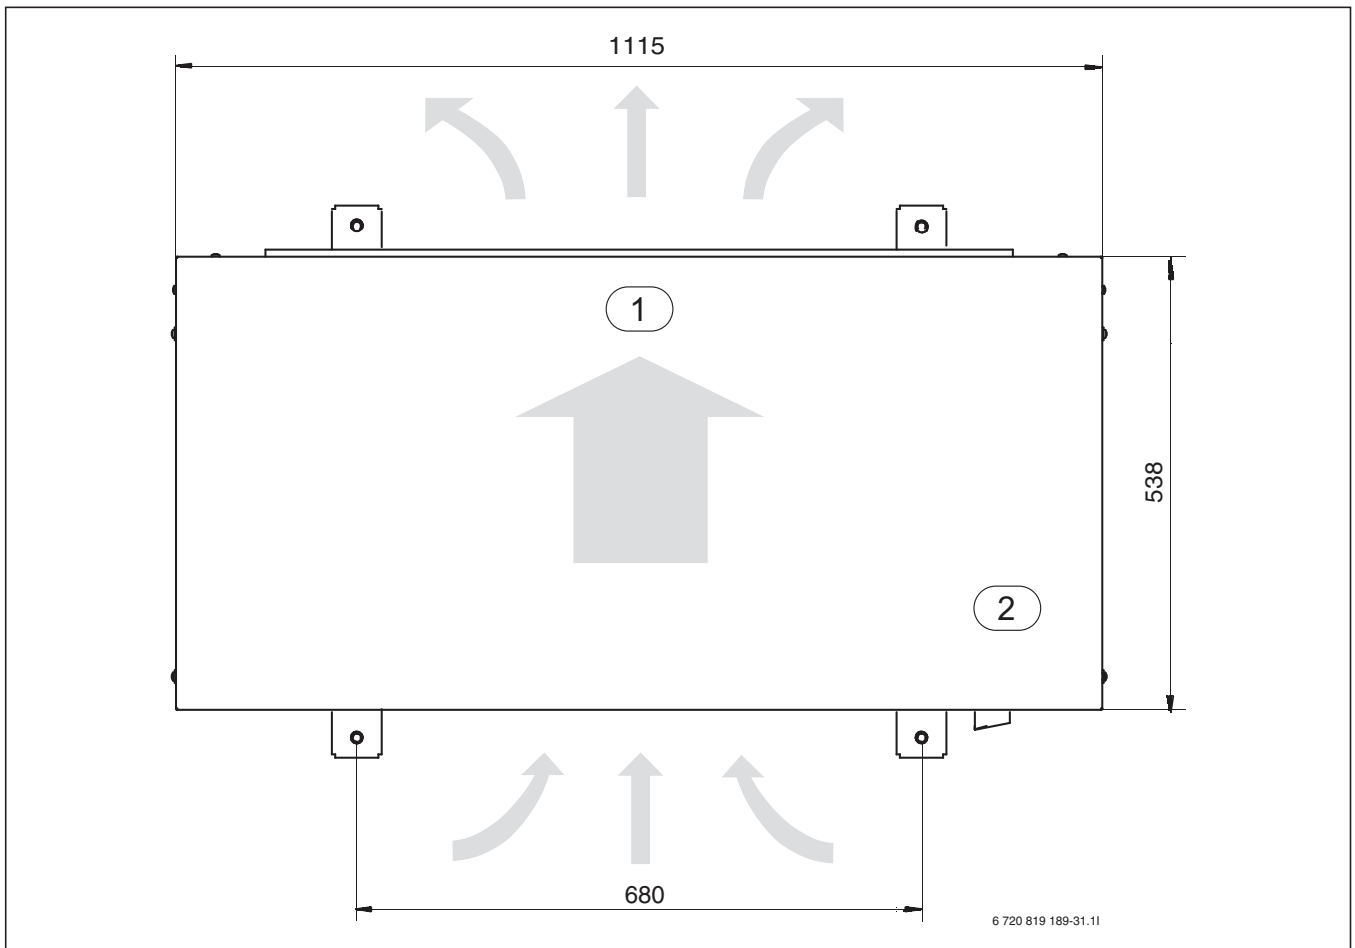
Abmessungen IDUWP11 und IDUWP14, Draufsicht (Maße in mm)
